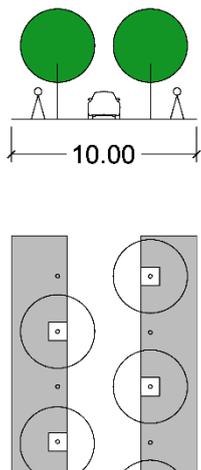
Propuesta de Sección Tipo II. Fuente. Elaboración propia.
